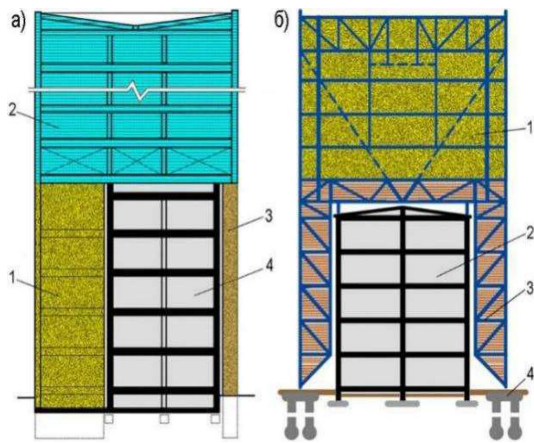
Схемы реконструкции зданий (вертикальные поперечные разрезы):
